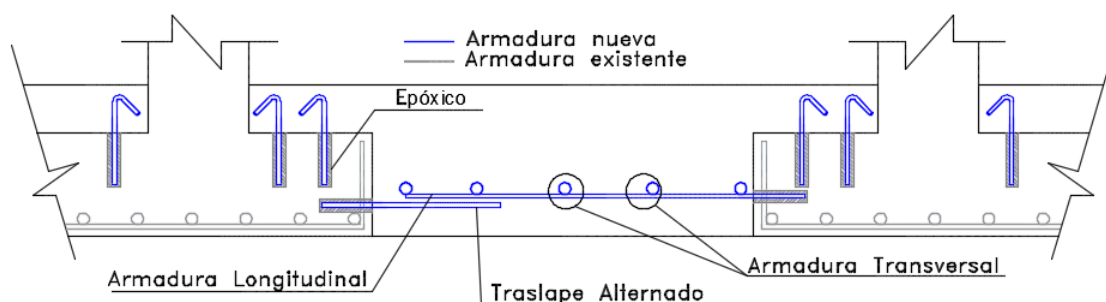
Conexión entre zapatas existentes y cimentación del muro
